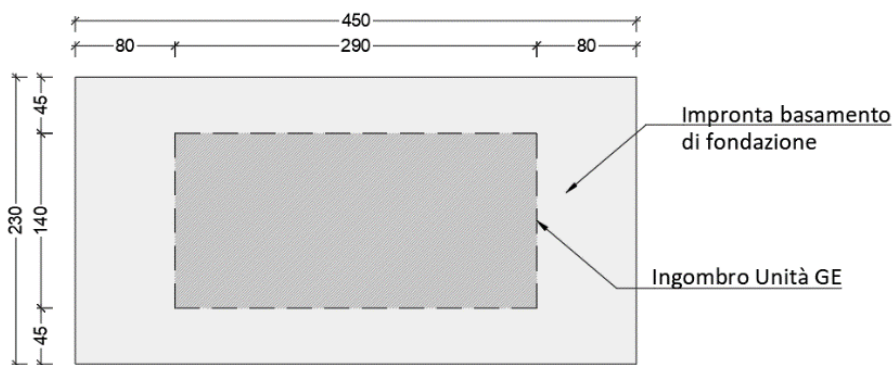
Schema dimensioni GE e platea di fondazione
